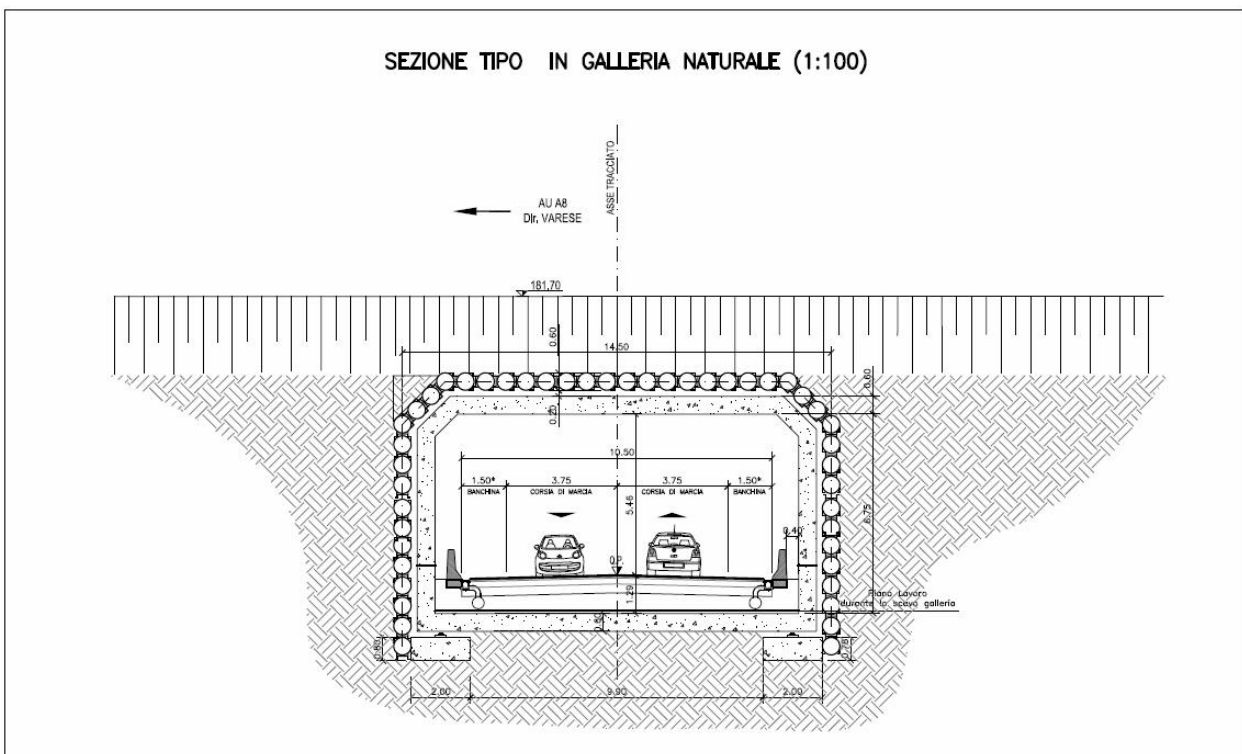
Sezione tipo - Galleria artificiale S.P.n.101
